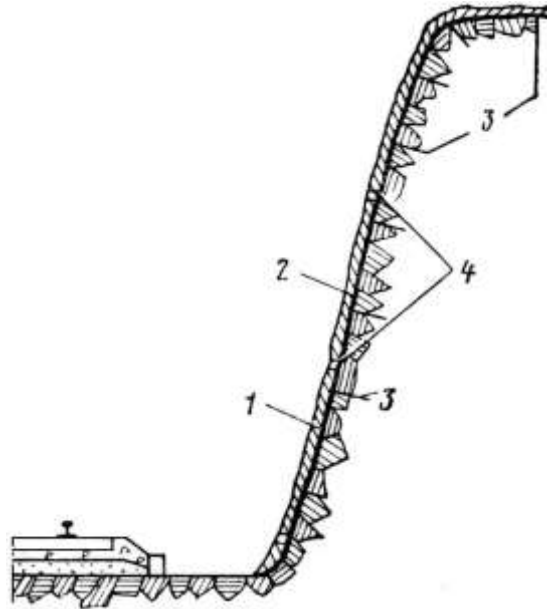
Покриття укосу бетоном, торкретом по арматурній сітці:
